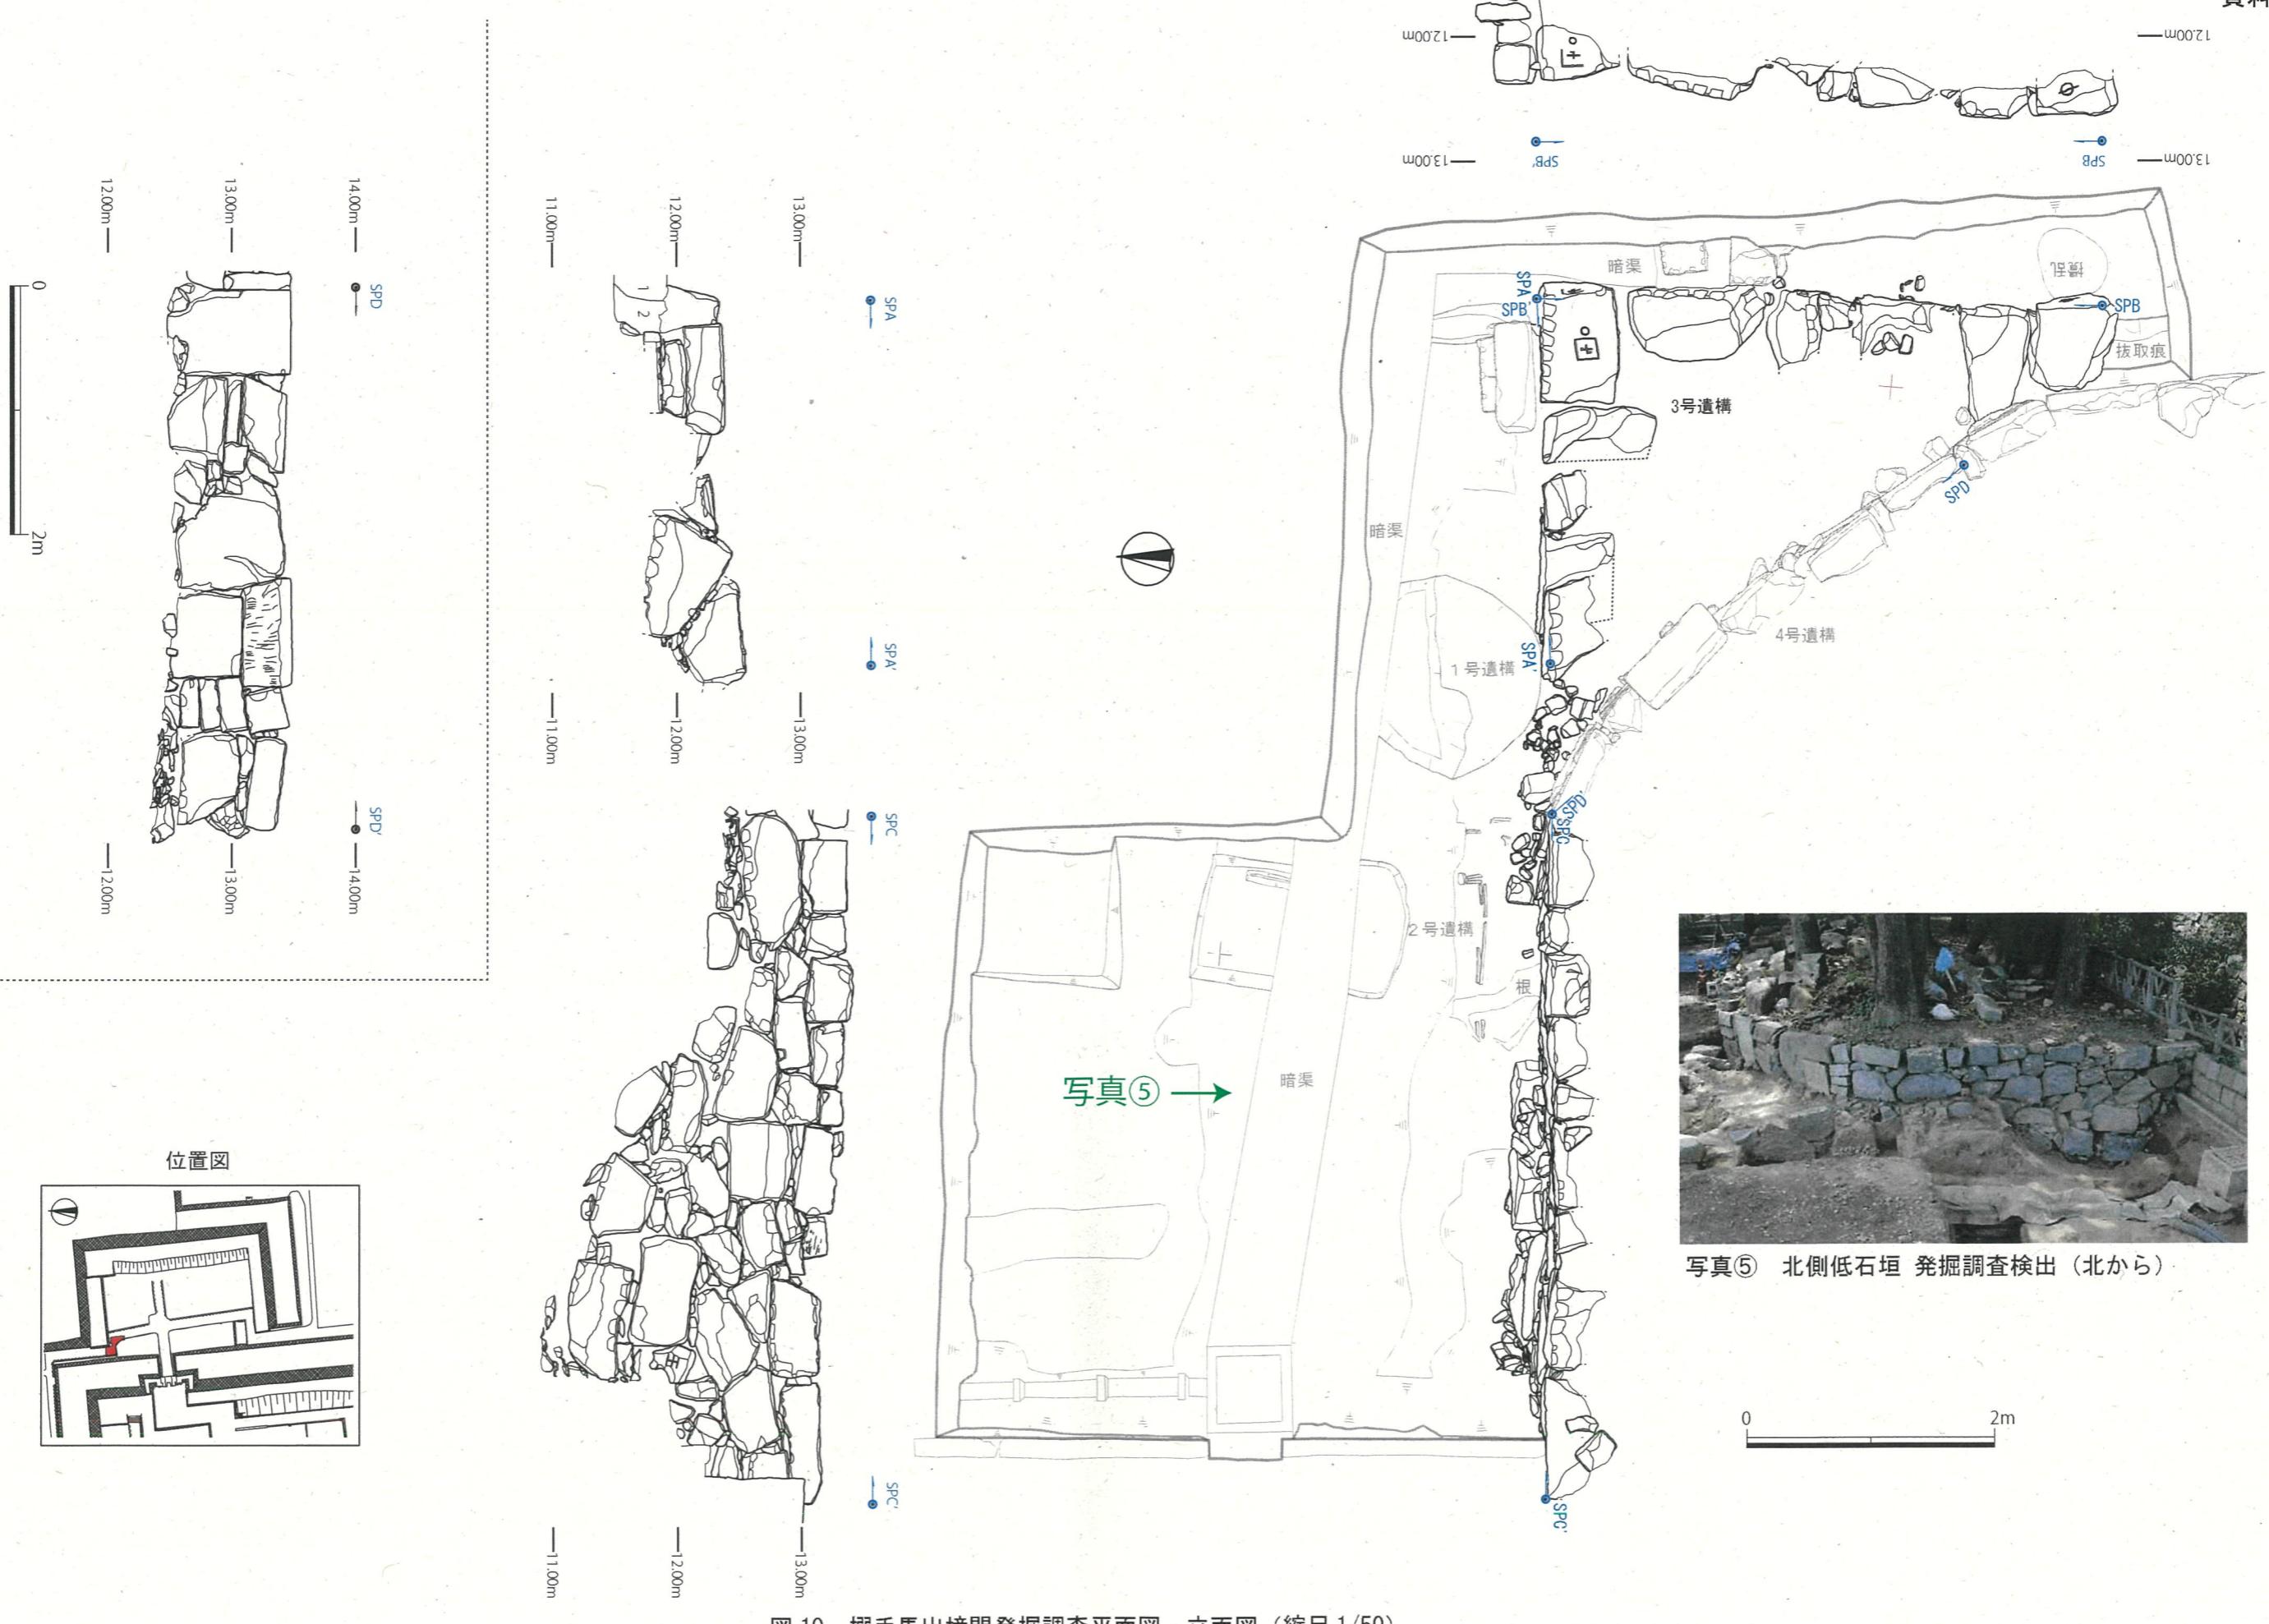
撫手馬出境門発掘調査平面図・立面図（縮尺 1/50）
